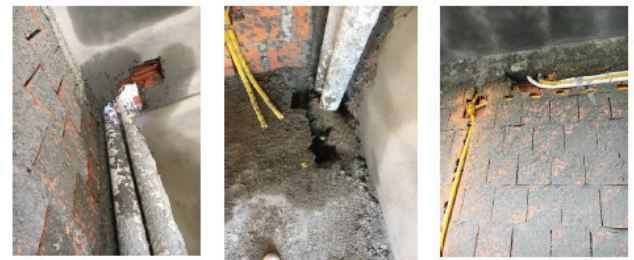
Interferências entre as disciplinas em canteiro de obras: (a) e (b) furo na laje e (c) furo na viga para tubulações
